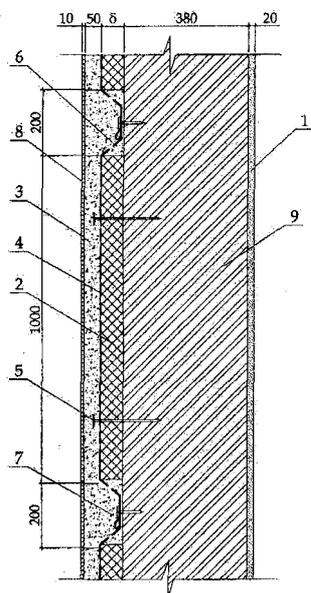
Конструктивное решение сборно-монолитной теплоизоляции из плитного пенополистирола и торкретполистиролбетона: 1 – кирпичная кладка; 2 – пенополистирол; 3 – полистиролбетон; 4 – армирующая сетка; 5 – дюбель-анкер; 6 – петля крепления сетки; 7 – дюбель-гвоздь; 8 – защитное покрытие;  $\delta$  – толщина пенополистирола (определяется по расчету); 9 – известково-песчаный раствор
